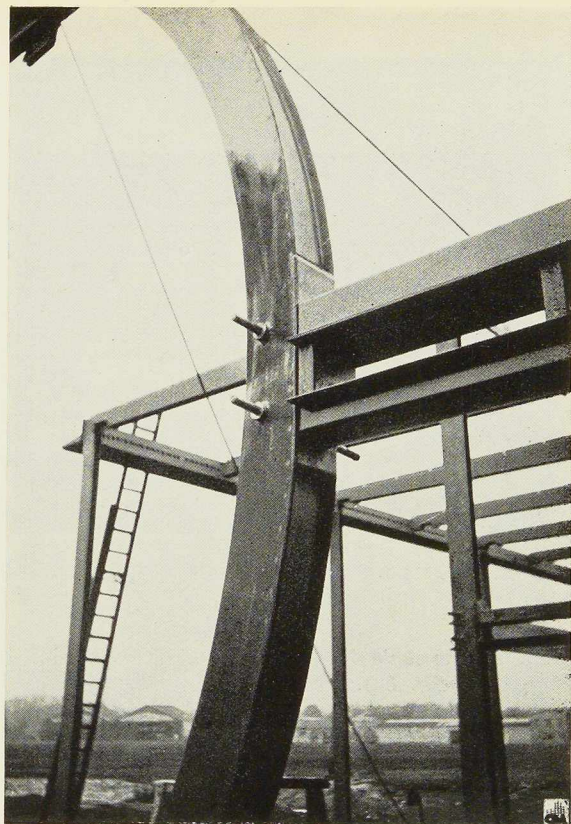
Une des poutres entourant la mappemonde. Malgré la forme exceptionnelle de cet élément l'assemblage avec la poutre transversale est du type classique.
